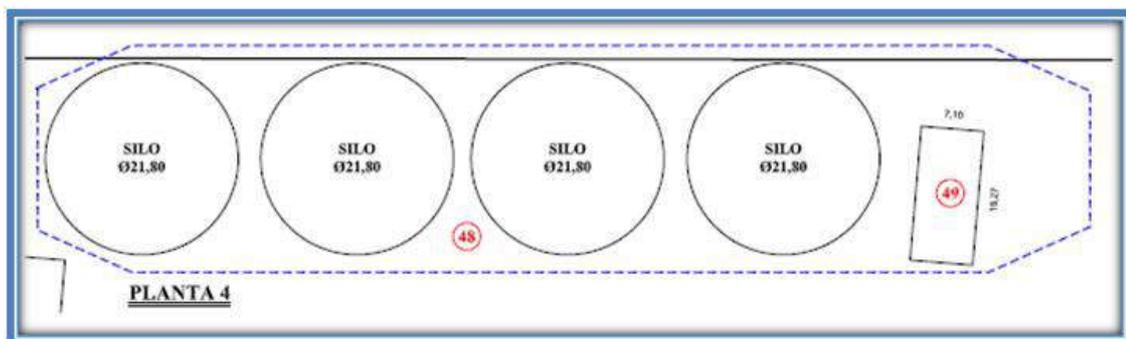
Planta de Silo 4 (Ref. n° 48) y Caseta de descarga (Ref. n° 49)
